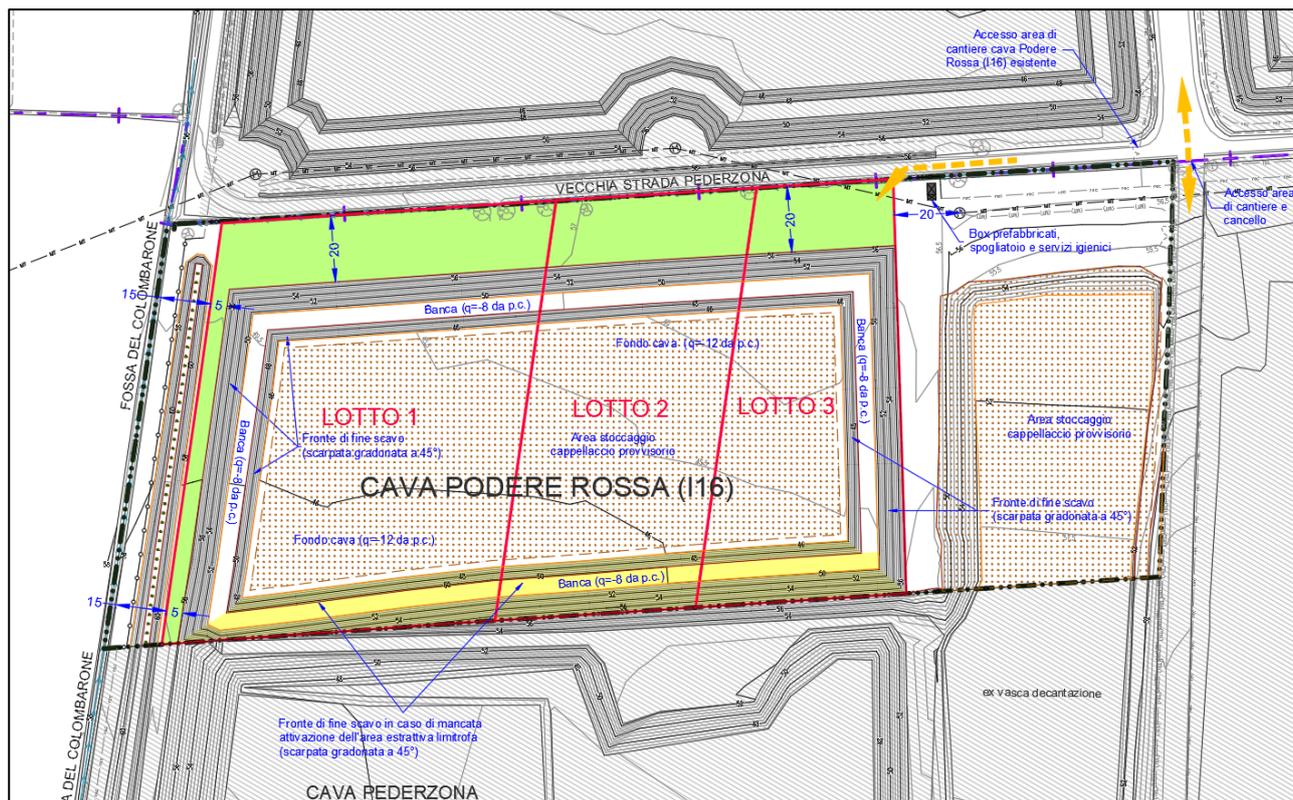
Stralcio della tavola T05 (A) “Progetto – Planimetria minimo scavo – Vincoli DPR 128/59”, in verde le fasce di rispetto ai sensi dell’art. 104 del D.P.R. 128/59, in giallo il fronte di rilascio per mancato avanzamento degli scavi verso la cava Pederzona.
